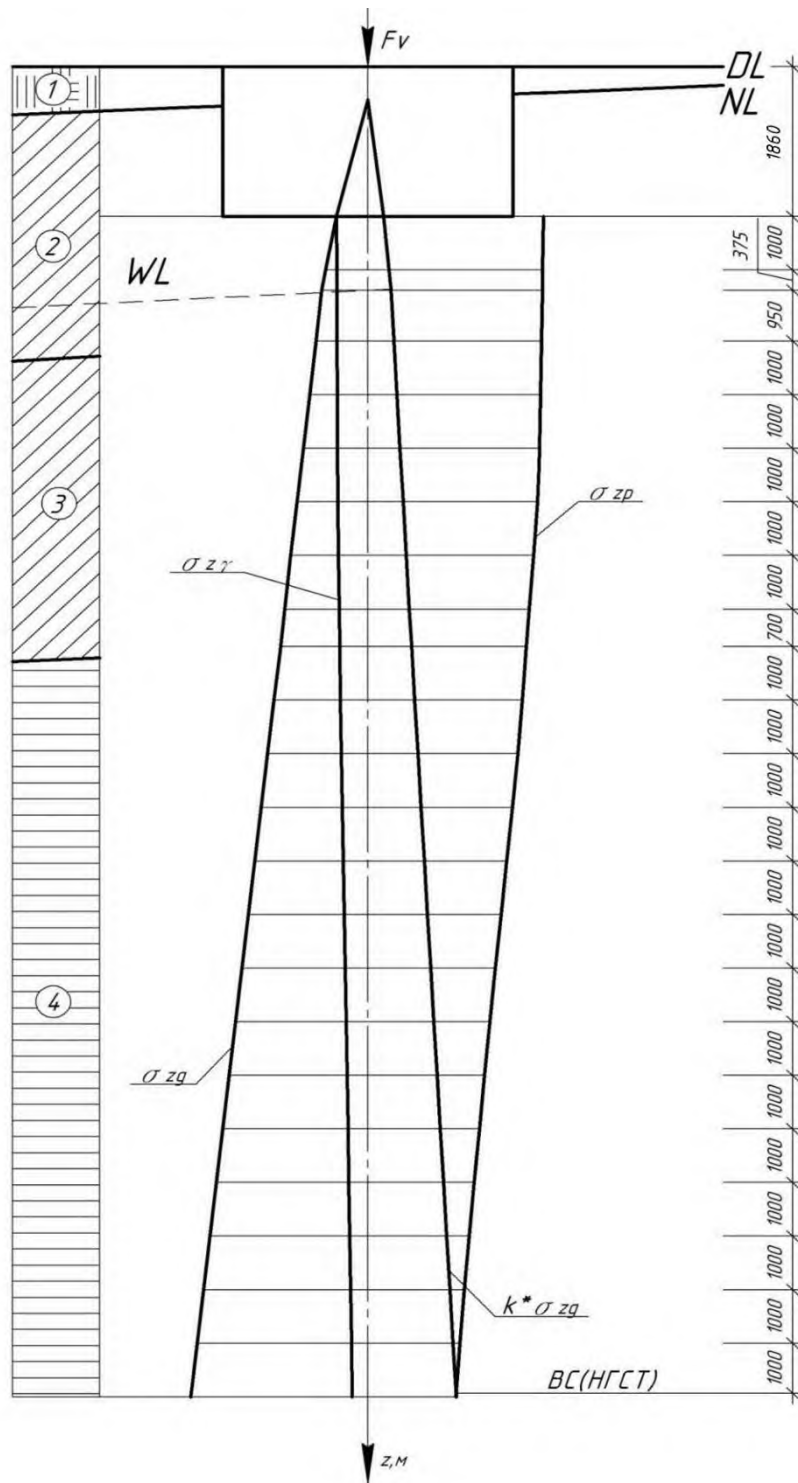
Розрахункова схема до визначення осідання фундаменту
